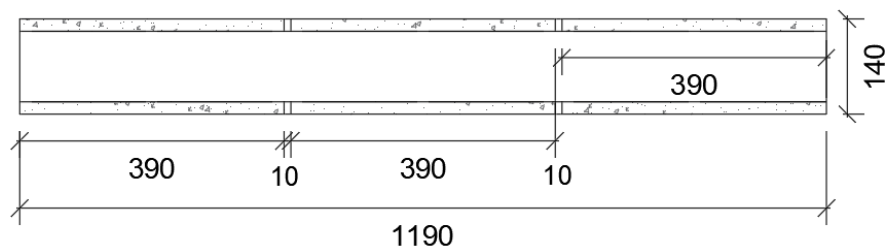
Viga de alvenaria estrutural construídas com blocos do tipo canaleta. Fonte: Próprio autor
